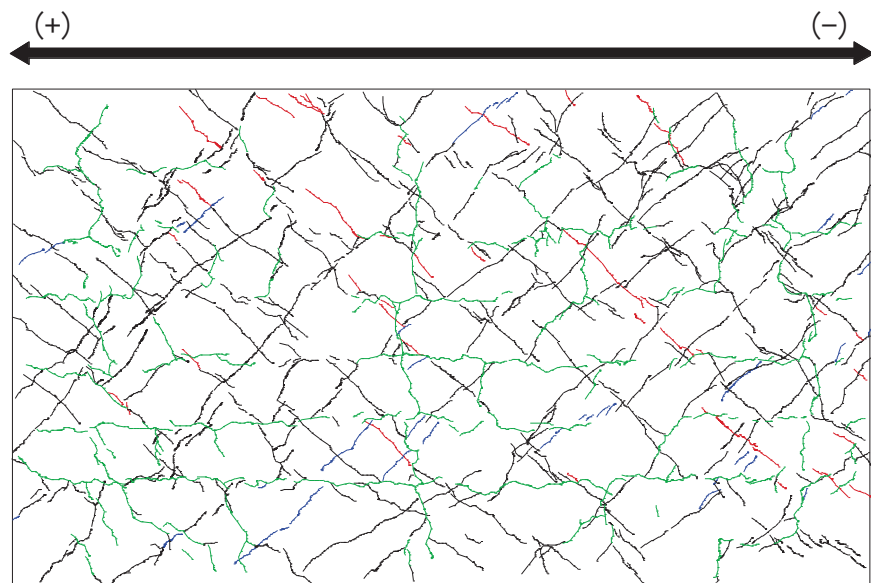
(10) 乾燥試験体 [2] 1/333rad. におけるひび割れ図
